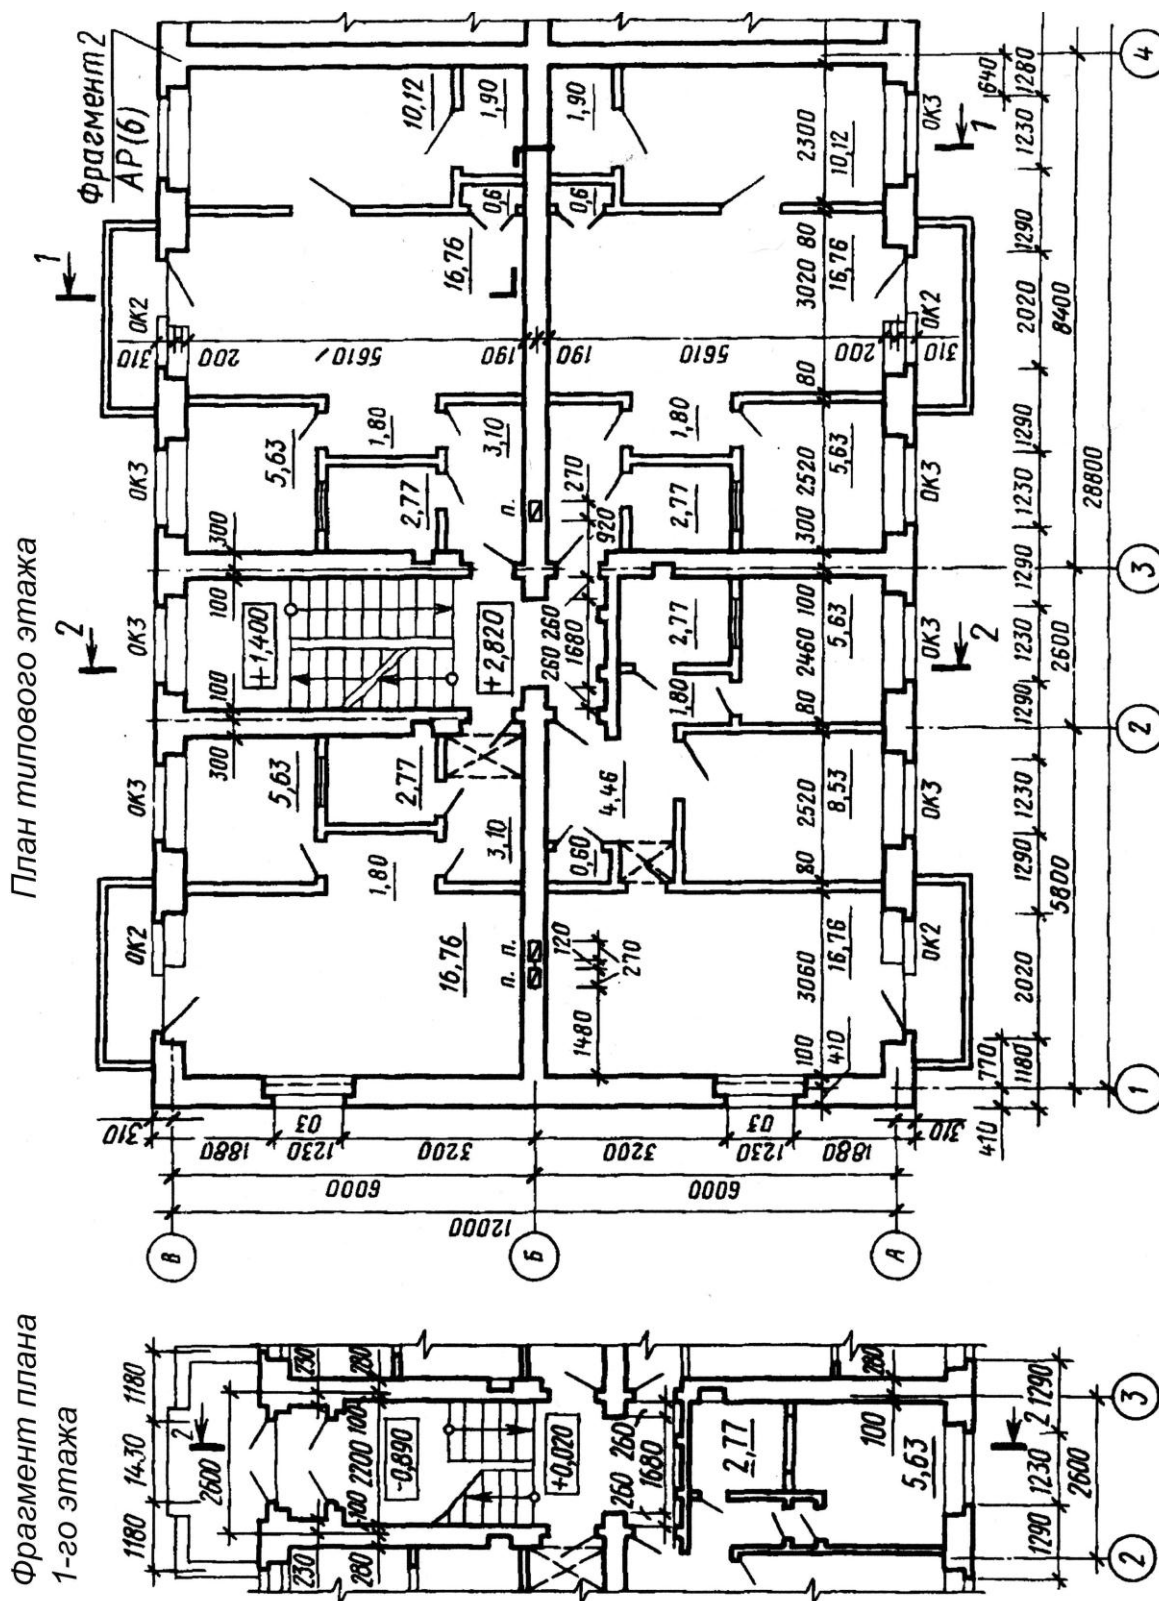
Пример выполнения плана жилого здания со стенами из мелкогазобетонных элементов
